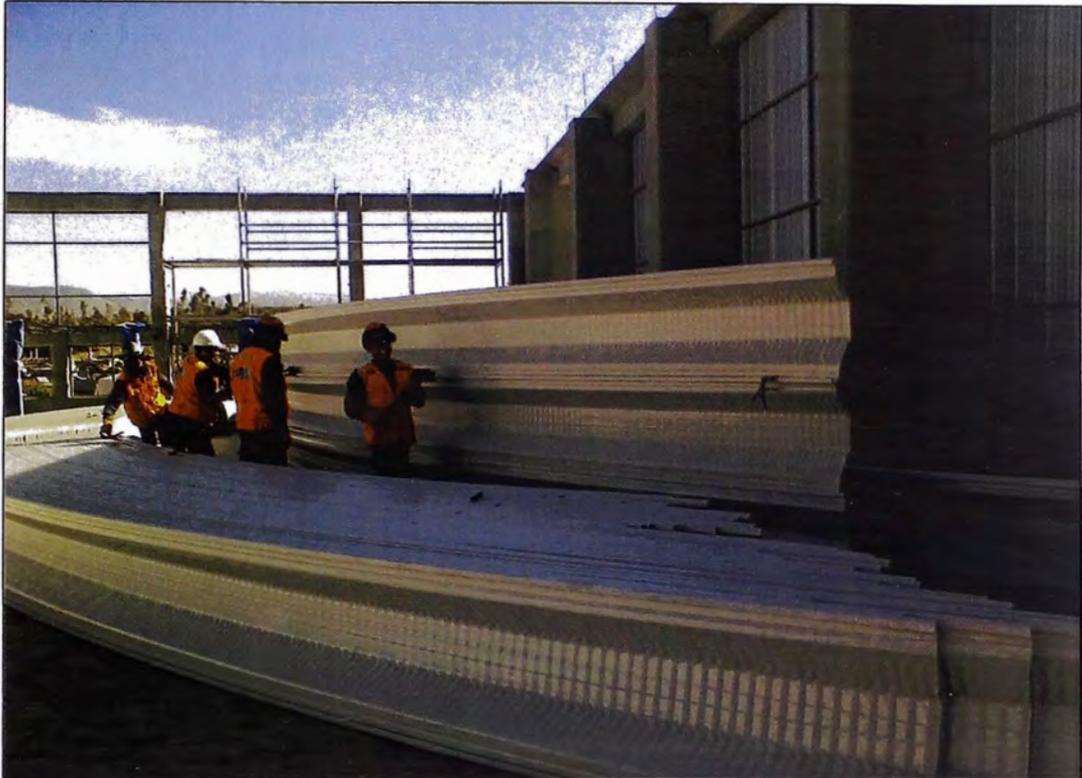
Panel plano previo al curvado (Referencia 16)
